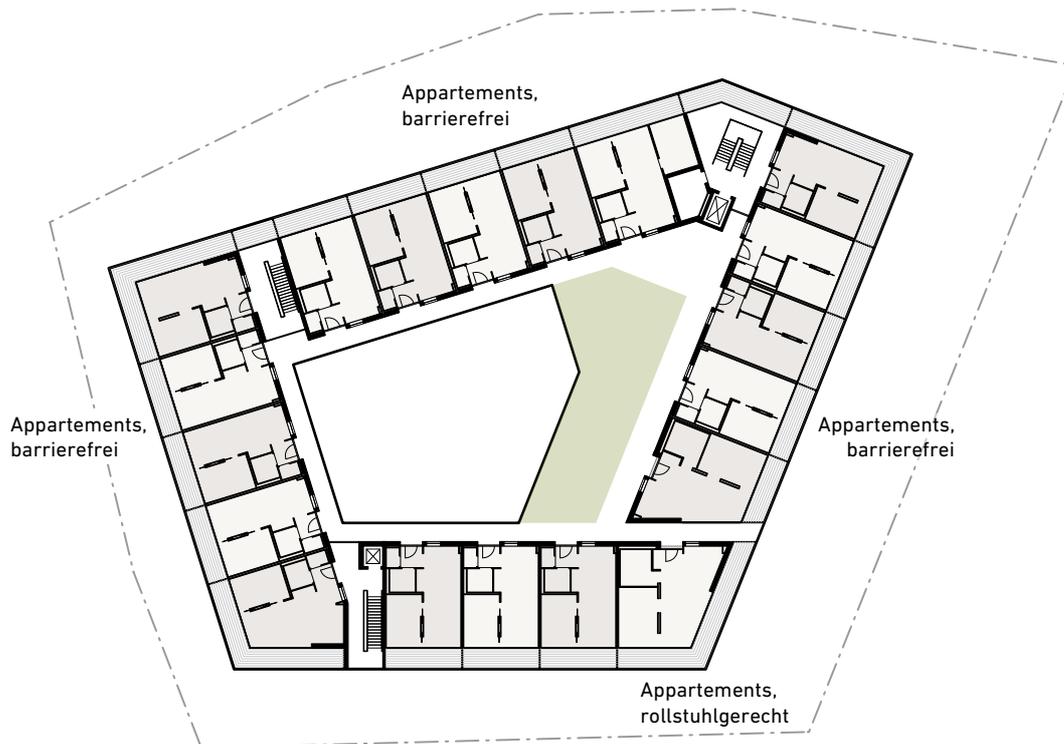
Das Vorhaben - Grundriss 3.Obergeschoss (Vorentwurf)
